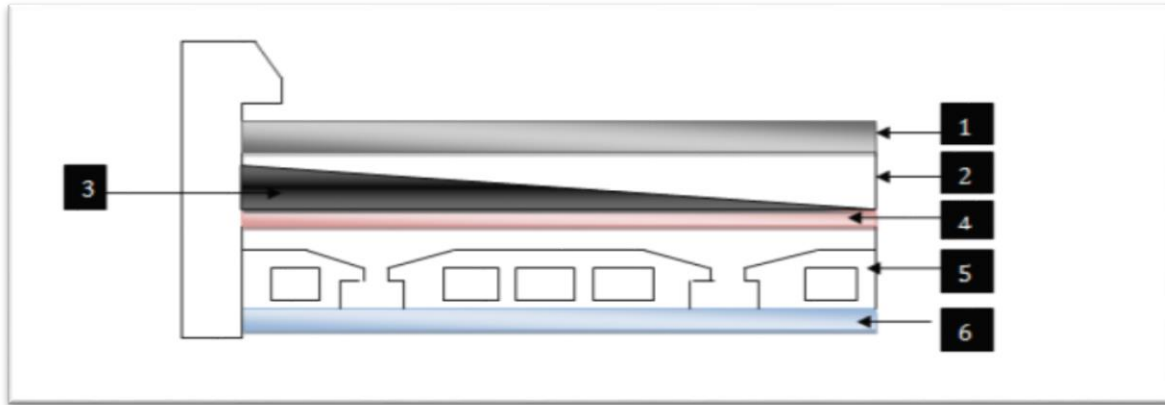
Coupe transversale au niveau de plancher terrasse
